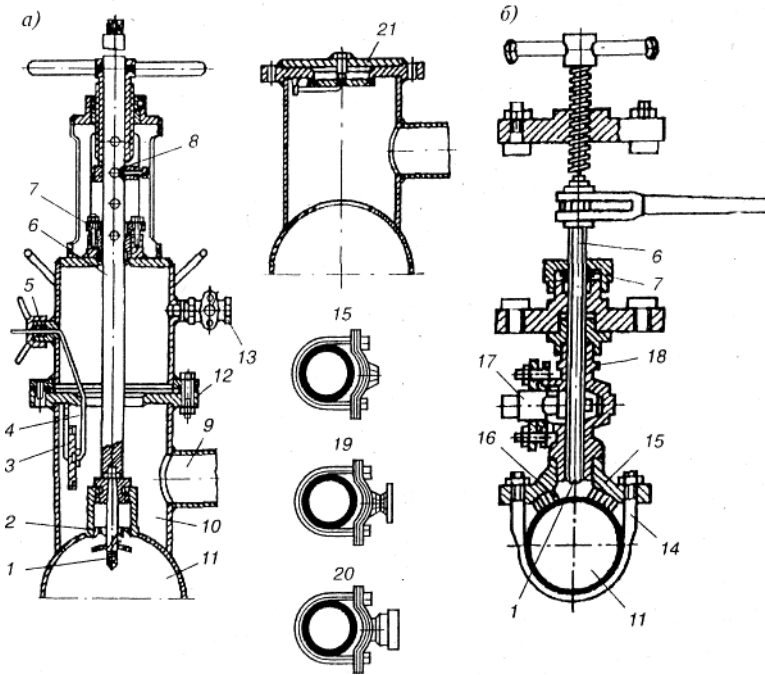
Приспособления для врезки вводов внутреннего водопровода в действующий стальной наружный водопровод:
